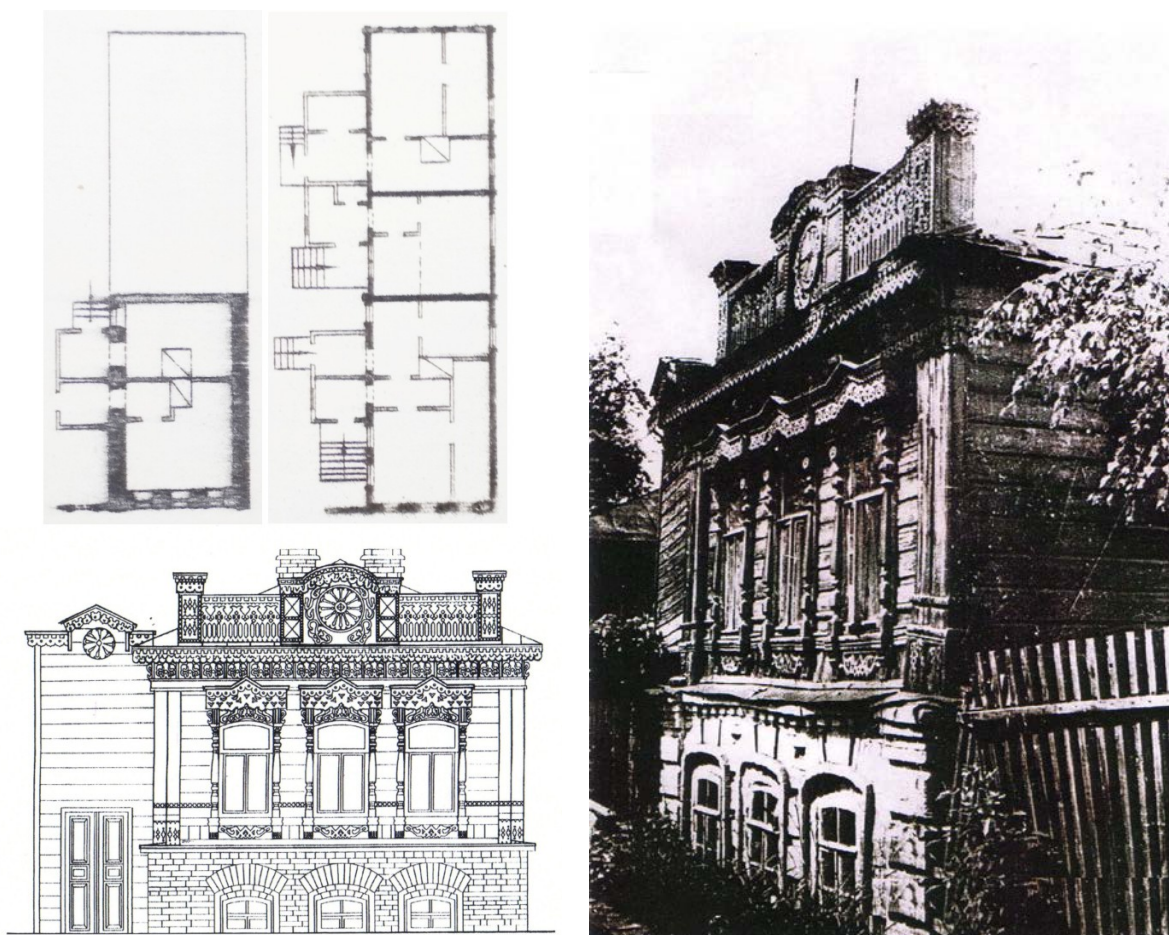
План цокольного и 2 этажа жилого дома по ул.Гоголя, 33.
